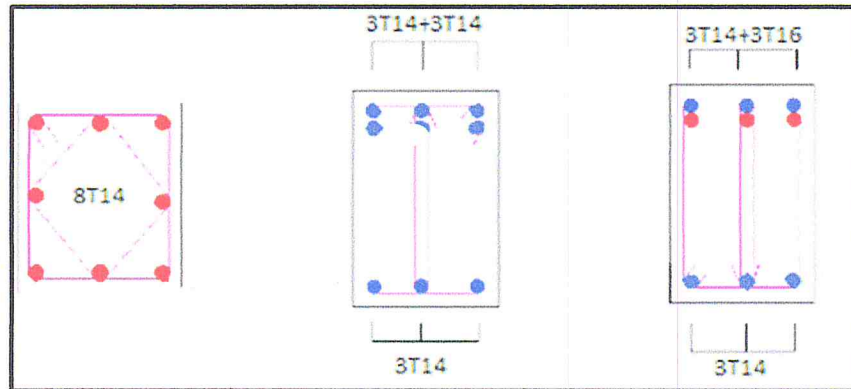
Ferrillages des poteaux et des poutres du bâtiment.
